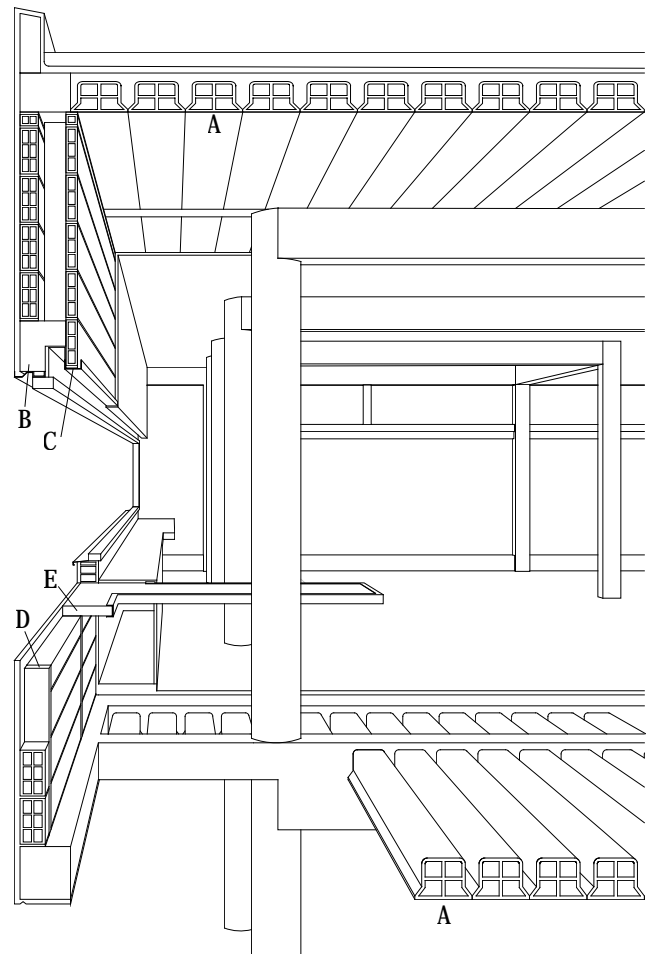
Sección fugada constructiva de la fachada noroeste de la *Villa Savoye*. A) bovedilla cerámica h: 12- 18 cm; B) dintel en "L" colgado; C) cargadero hoja interior "U" metálica; D) pilarcillo de hormigón en peto; E) balda de hormigón e: 6 cm. Fuente: elaboración propia.
